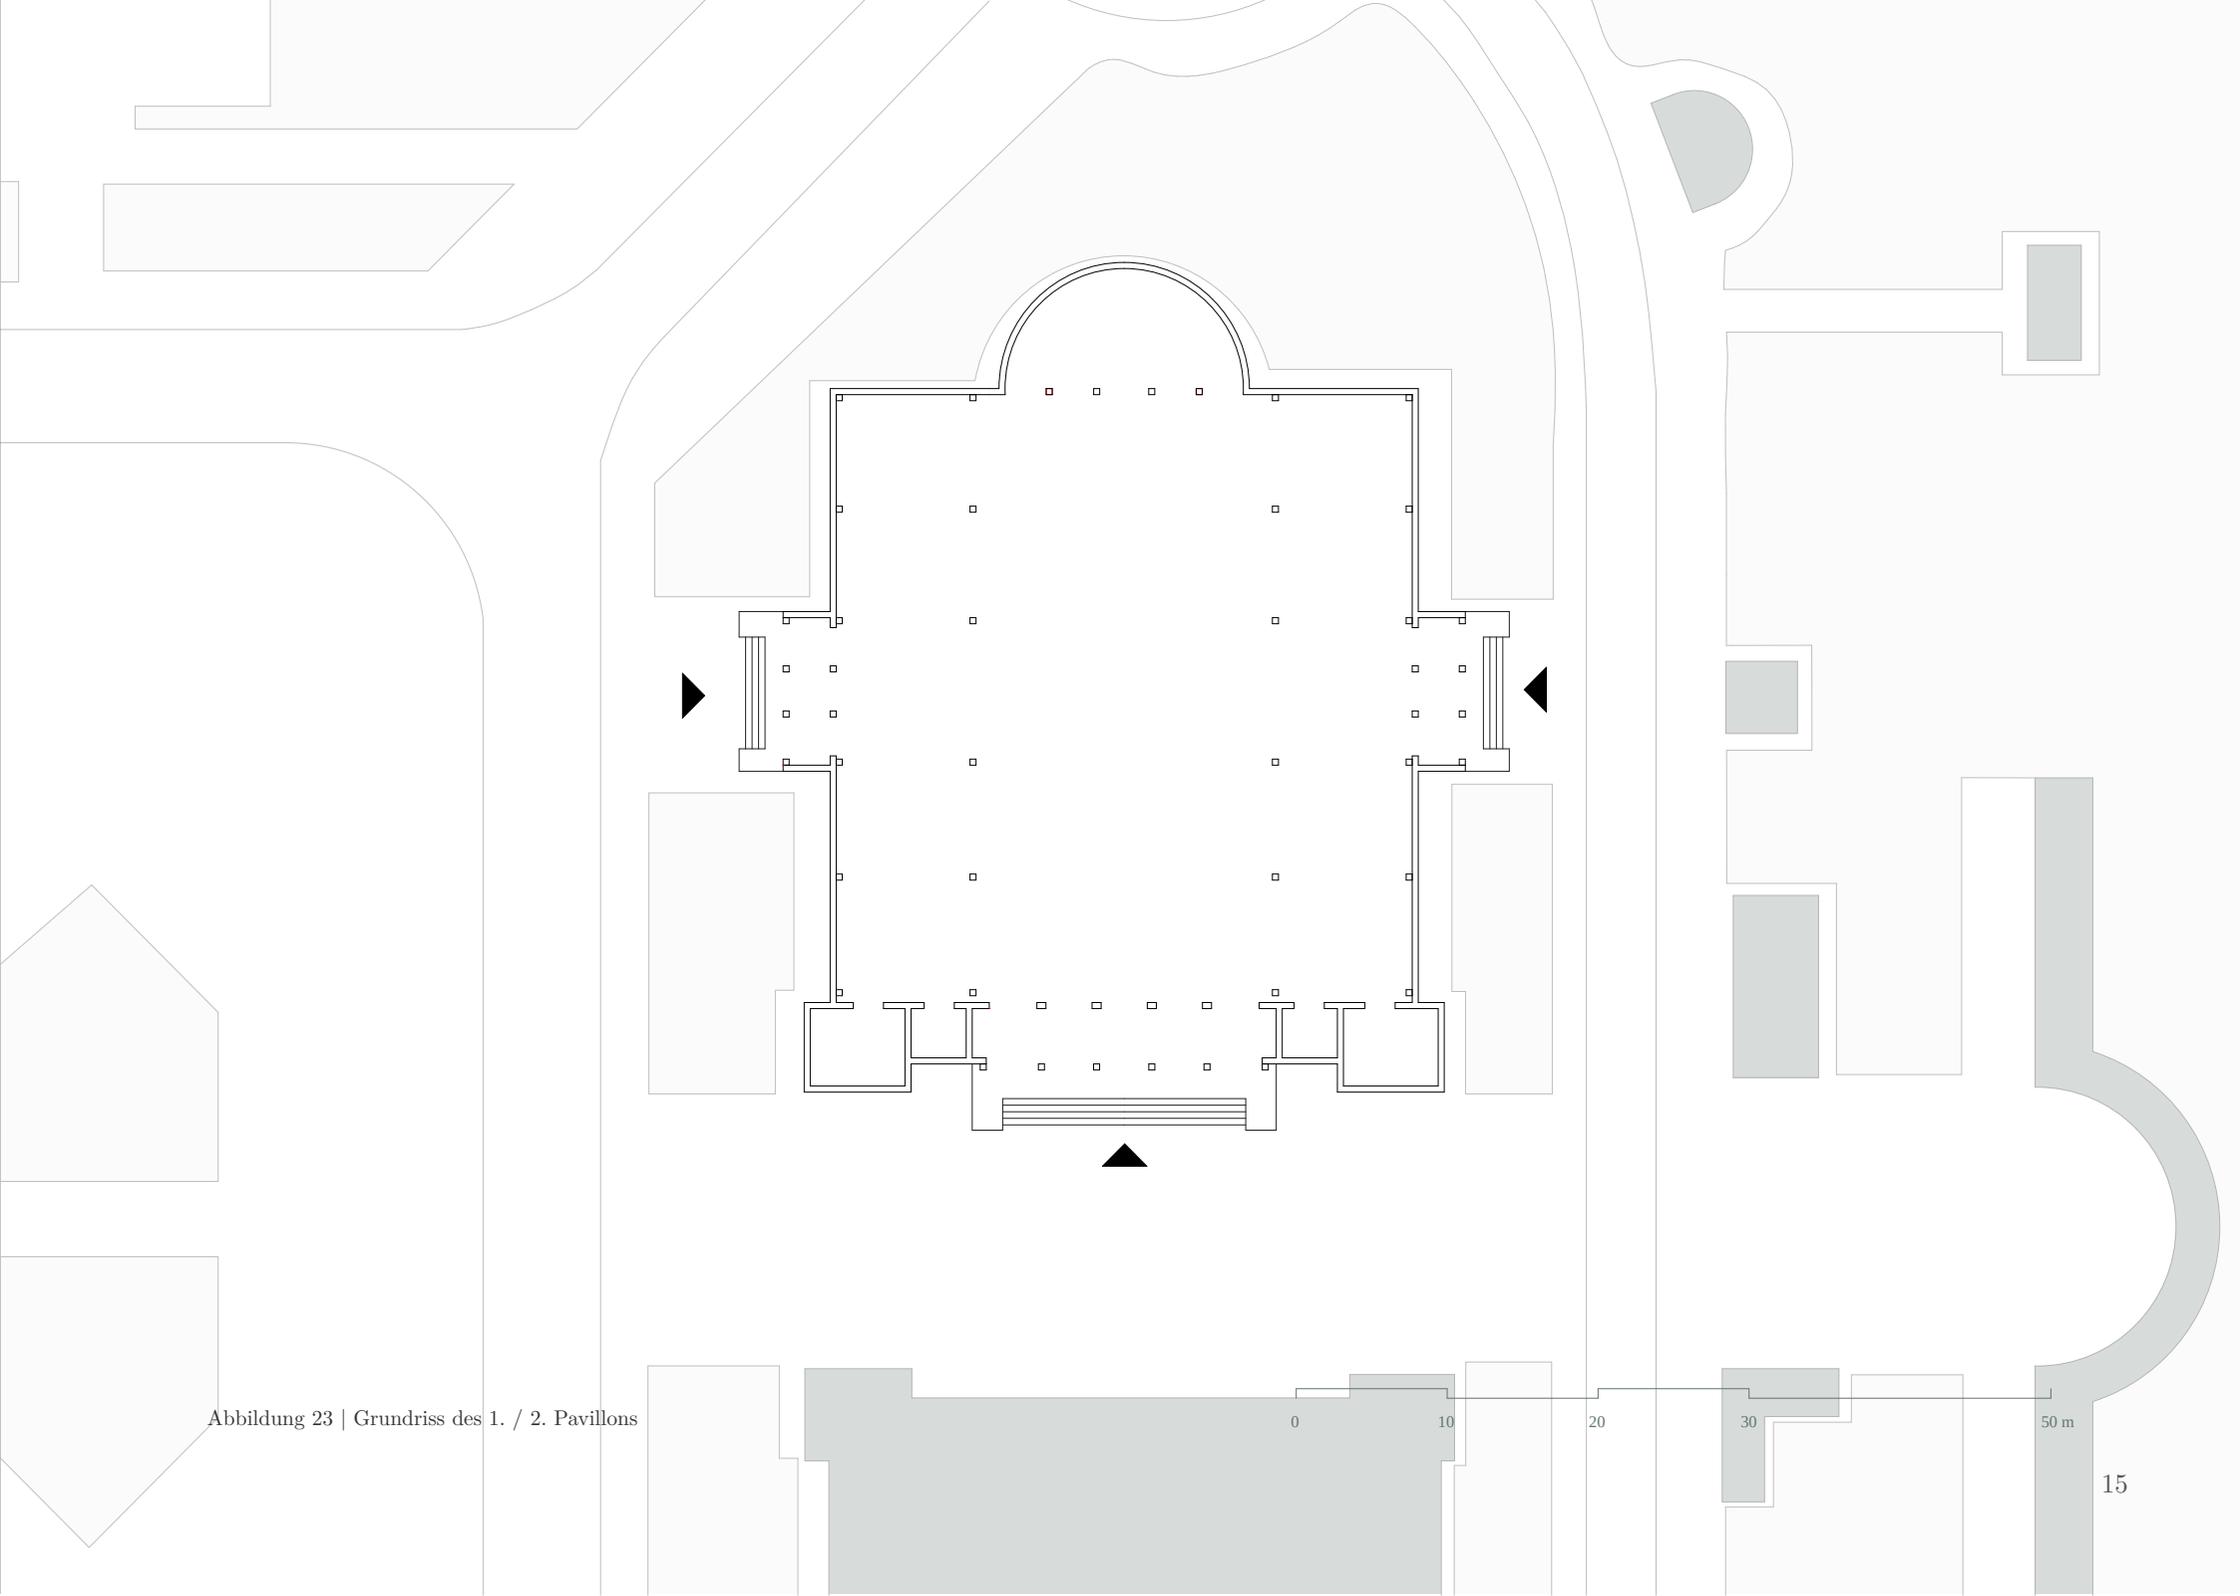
| Grundriss des 1. / 2. Pavillons
